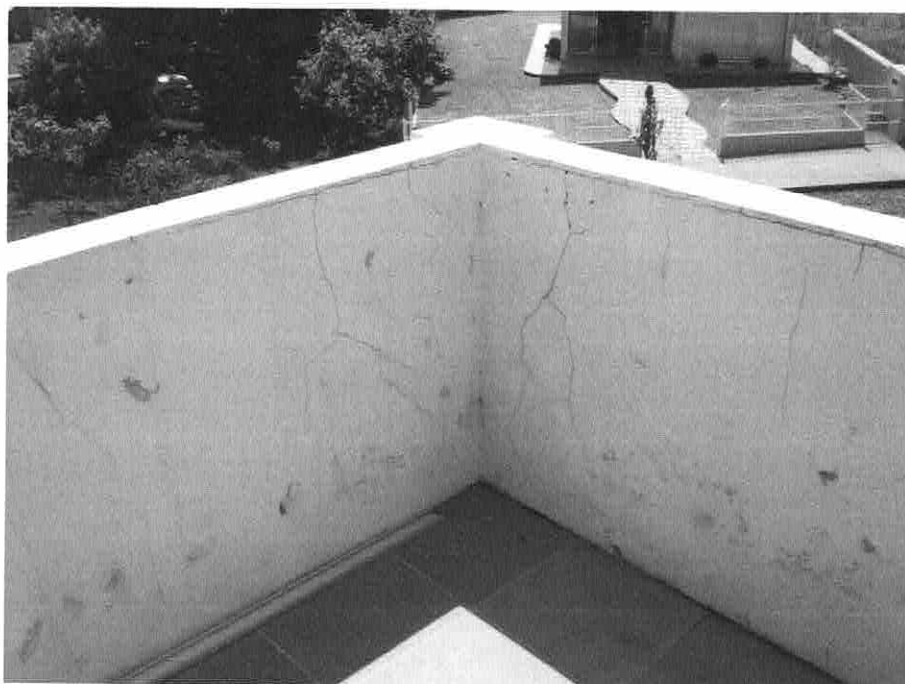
Fissuras decorrentes de traço mal feito
